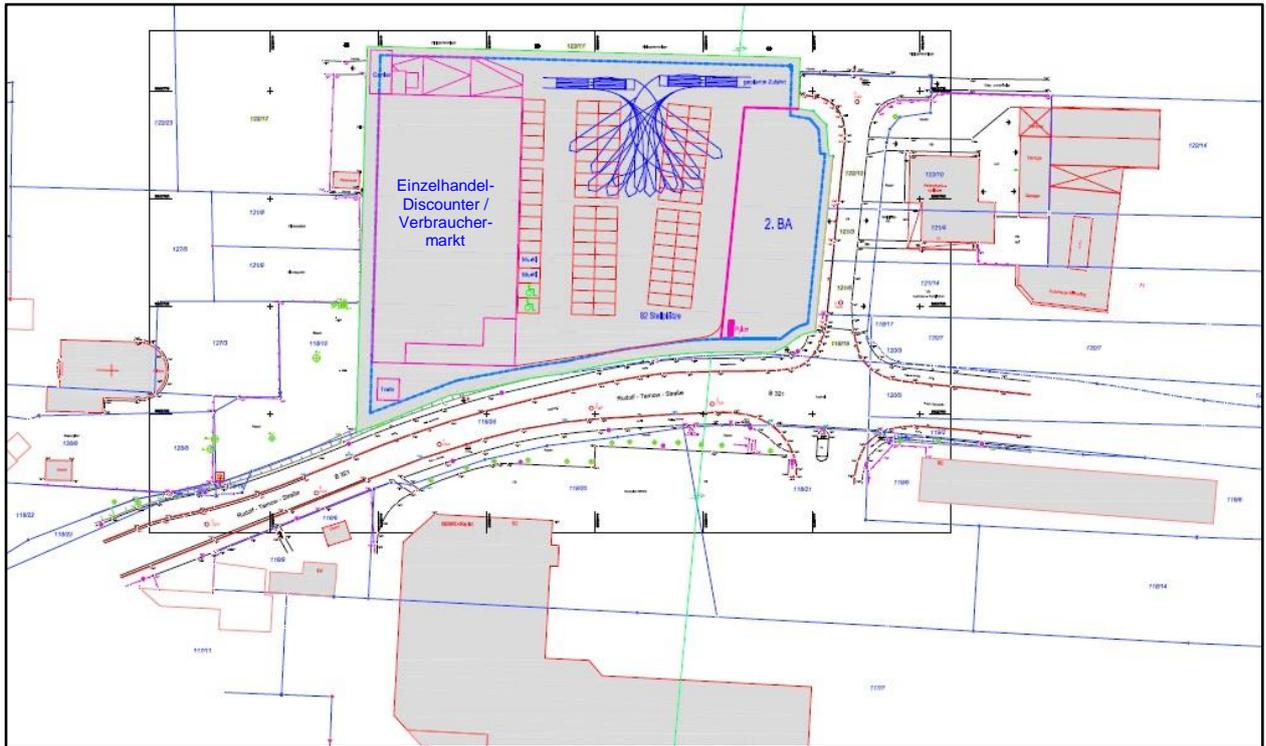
Lageplan des geplanten Verbrauchermarktes (Beispiel)
